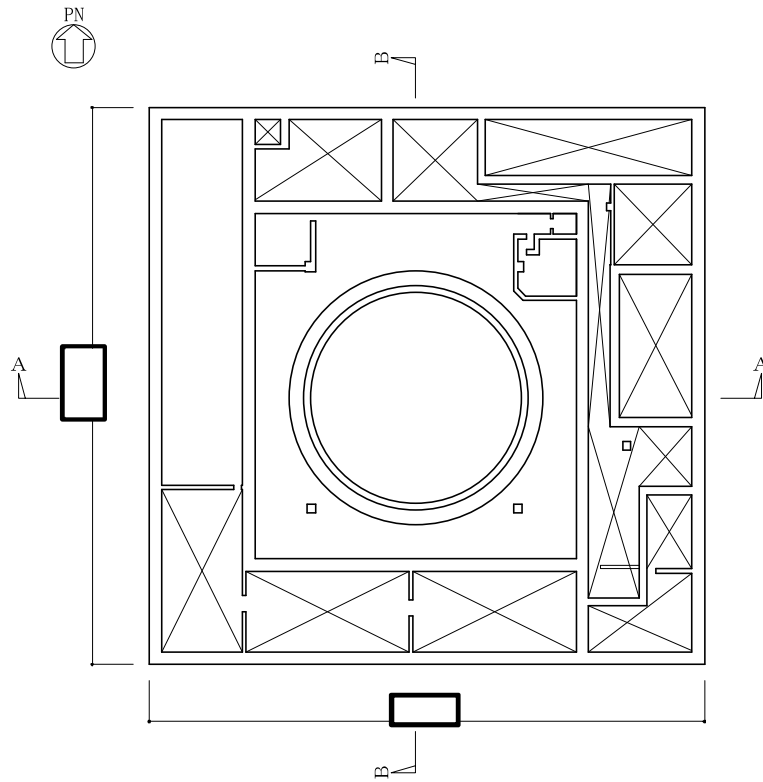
(2/9)  の概略平面図 (EL. 2.0 m)
